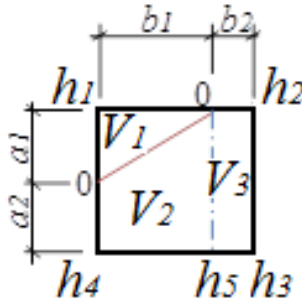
План элементарной фигуры планируемой площадки: схема фигуры, разбитой нулевой линией на треугольник и пятиугольник
